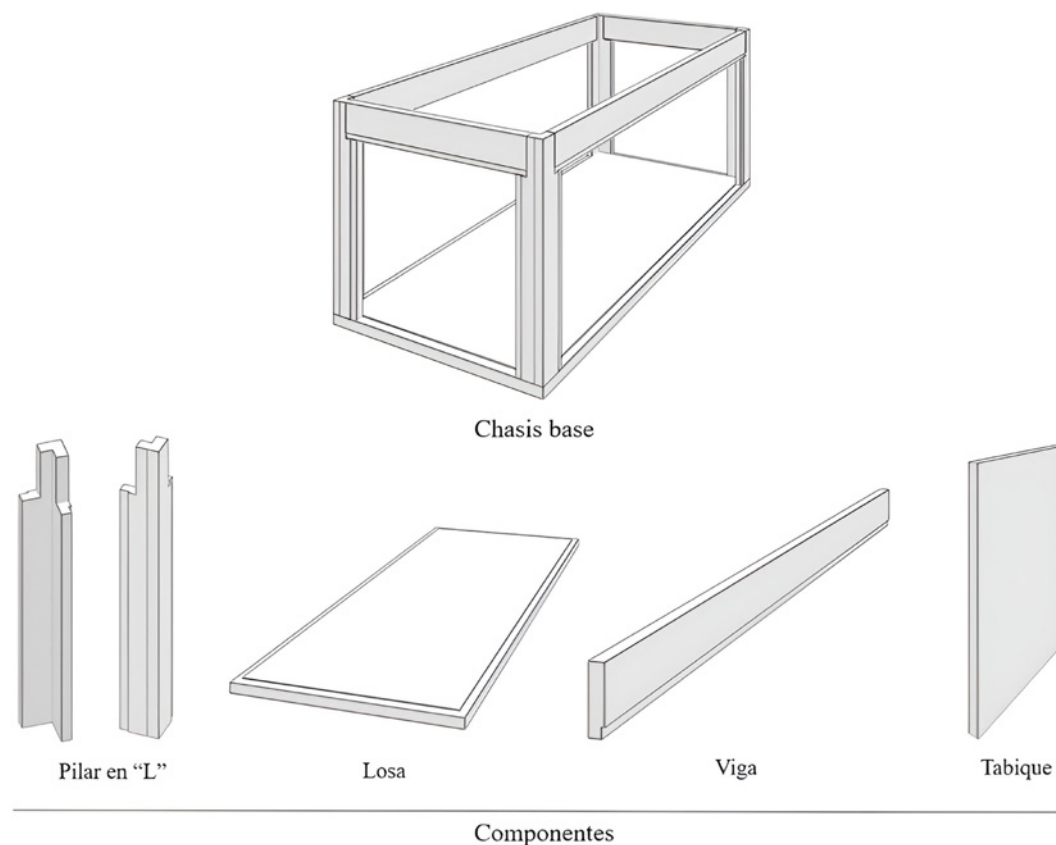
Sistema constructivo de los módulos multi-espaciales. Fuente: elaboración propia.
